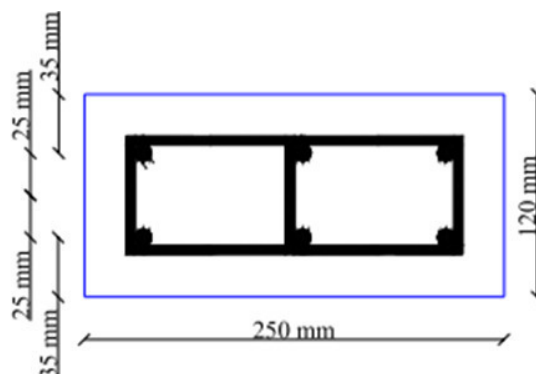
Detalhe da seção central dos pilares de Dantas (2006).
